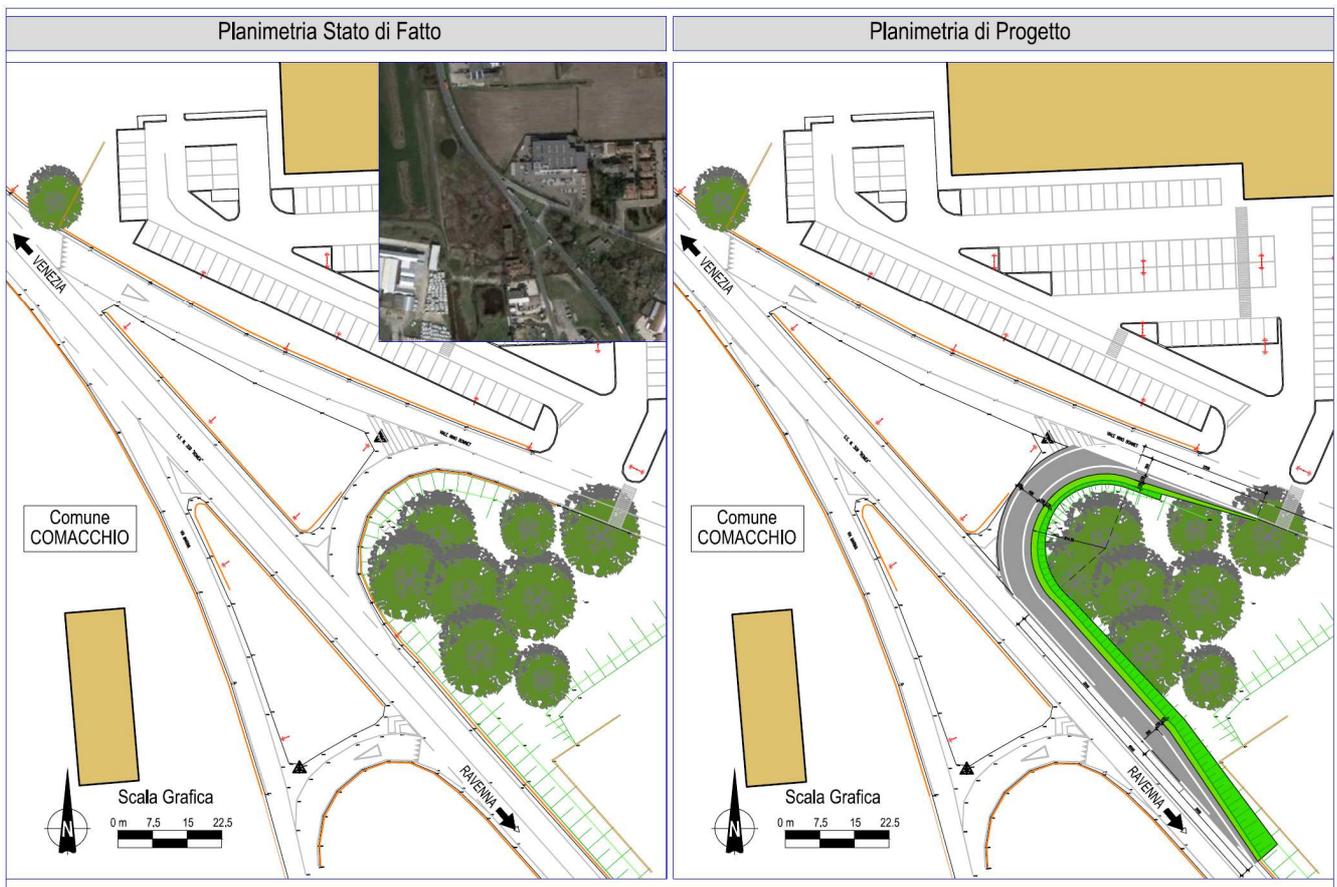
Intervento n° 8 – Planimetria Stato di fatto - Progetto
